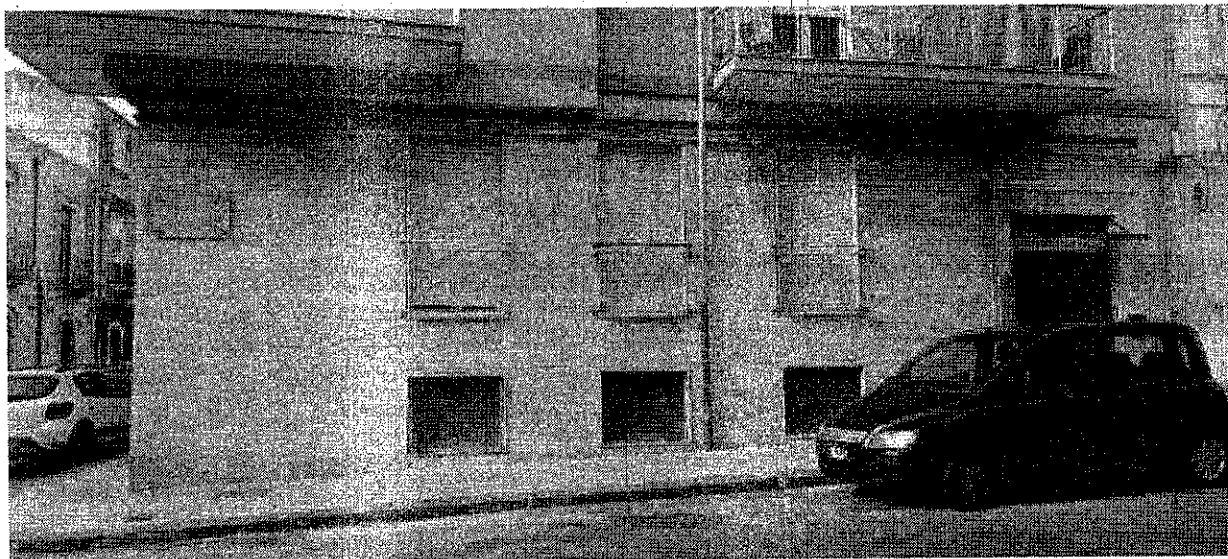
Immobile “1A” – Prospetto su via Fuggetta
